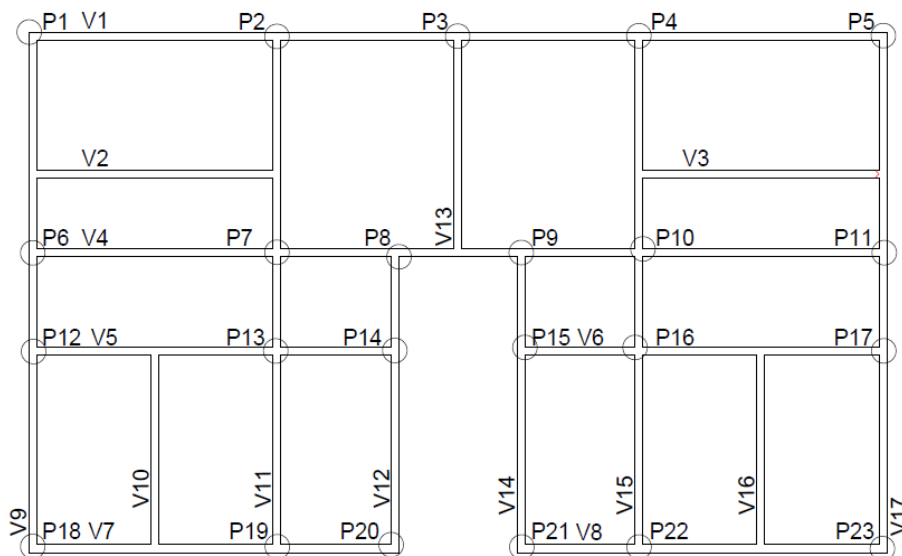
Esboço das reações de apoio das vigas nos pilares
